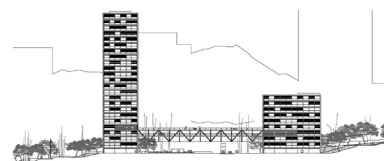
Alzado concurso viviendas para jóvenes y mayores en Benidorm. Javier García-Solera.
